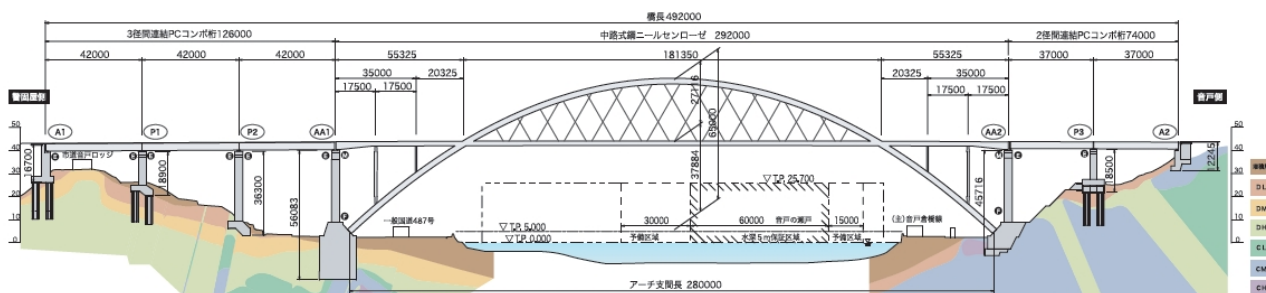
(仮称)第2音戸大橋側面図 (Figure 2: General drawing of the 2nd Ondo Bridge)
